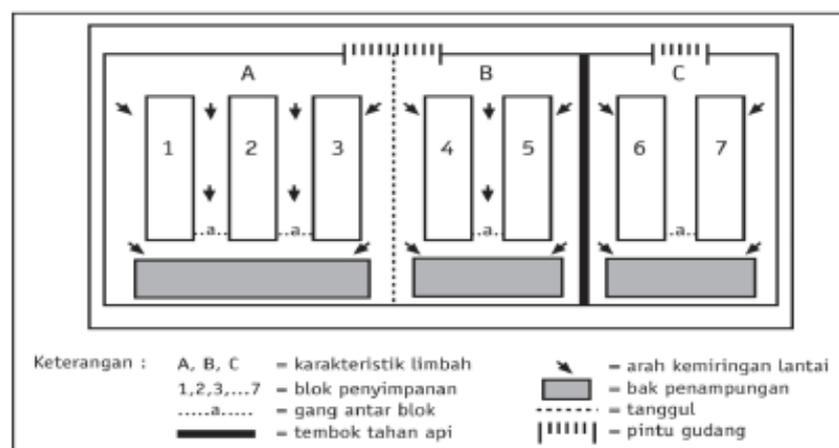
Contoh rancang bangun fasilitas penyimpanan limbah B3 dengan sirkulasi udara dalam ruang bangunan penyimpanan limbah B3
